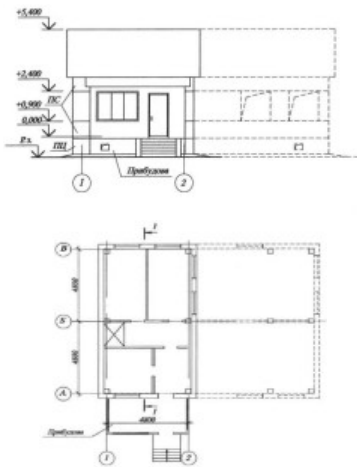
Основні технічні рішення: а - фасад 1-2, б - план на поз. 0,000 / Basic technical solutions: a – facade 1-2, в - plan at elevation 0,000
